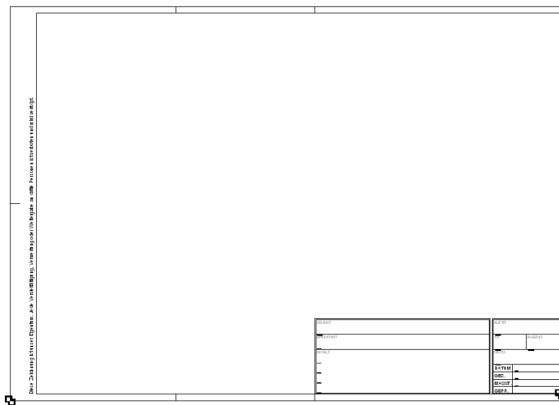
Einfügepunkte für Planrahmen und Plankopf
